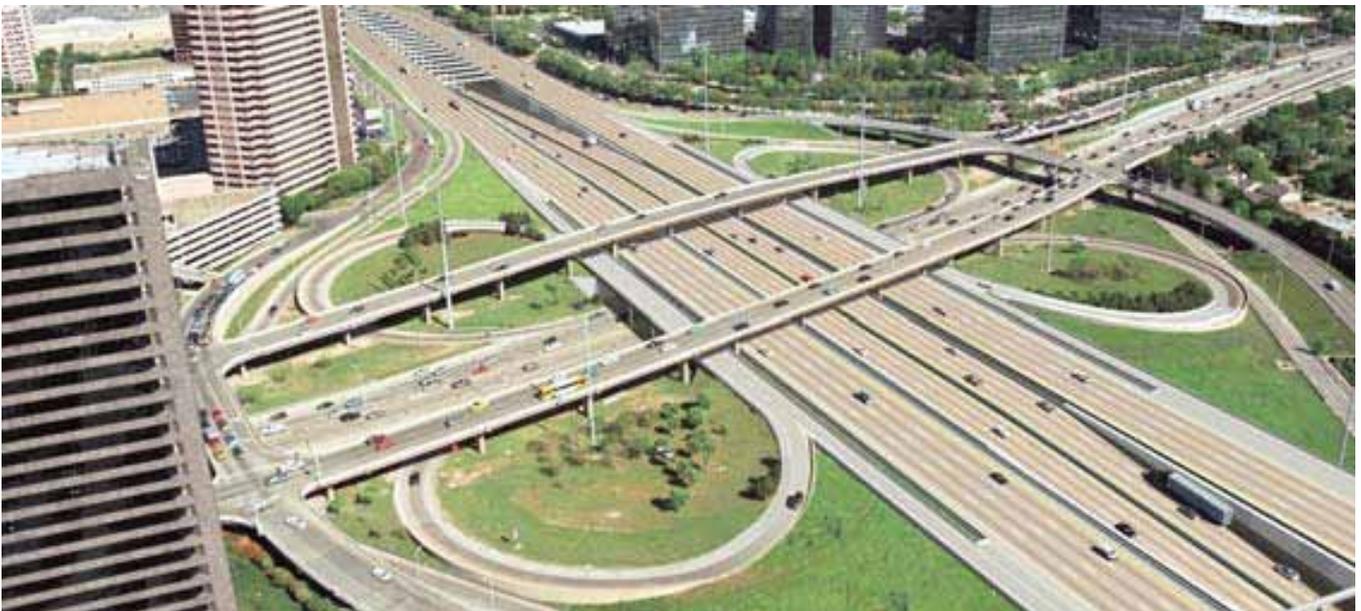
Enlace DNT: solución construida con tres niveles. Calzadas libres y peaje al mismo nivel
